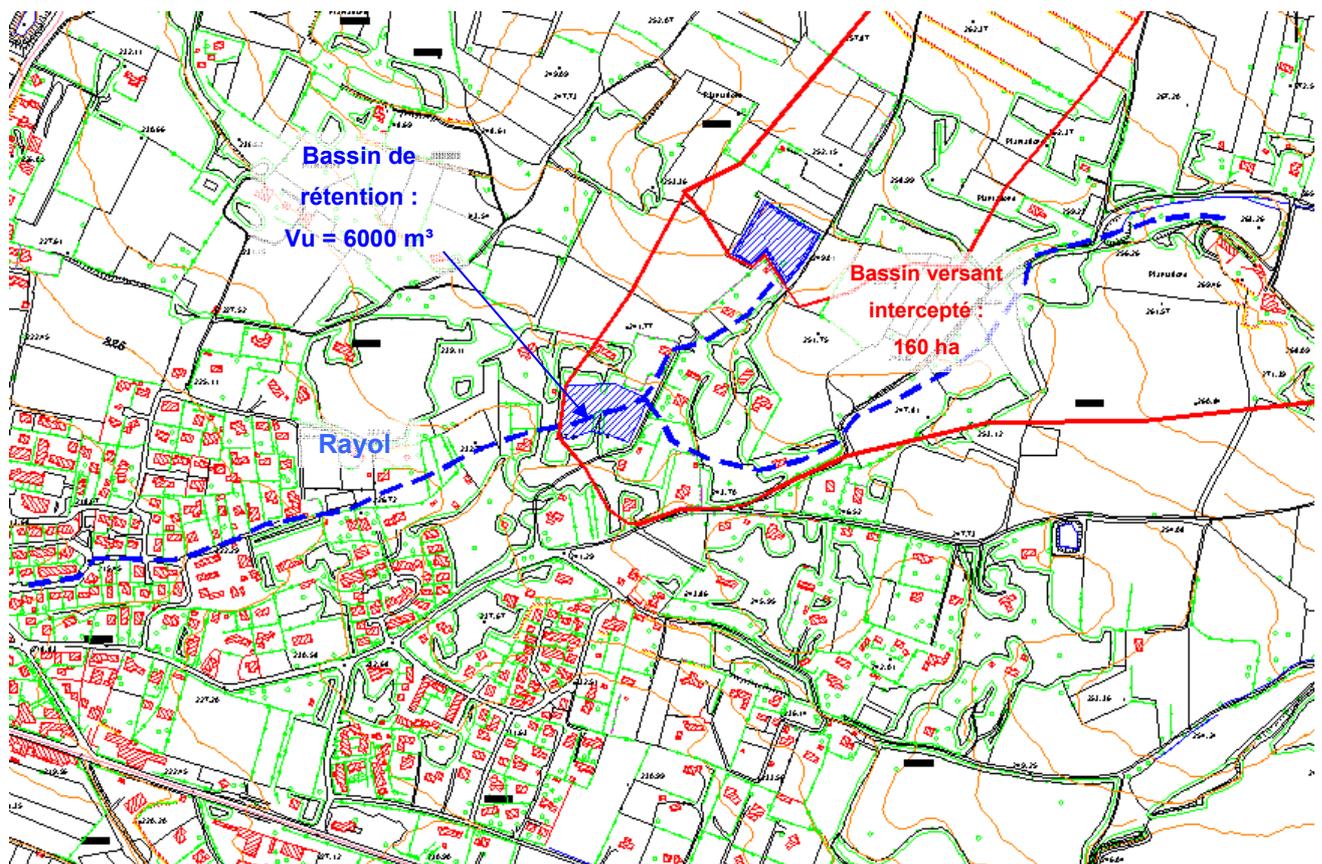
AMENAGEMENT 4 – VUE EN PLAN
